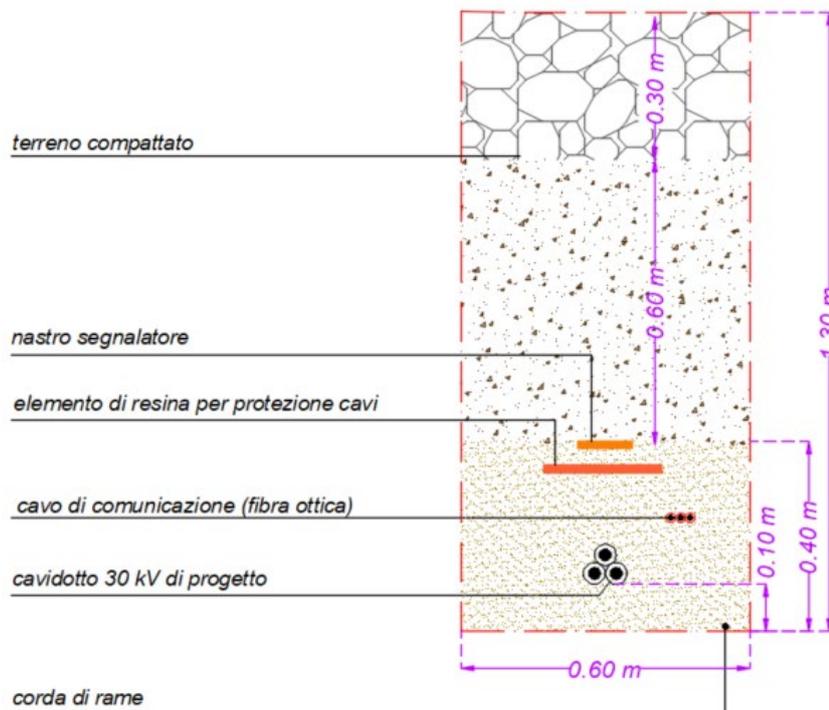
Sezione cavidotto singola terna su misto stabilizzato
